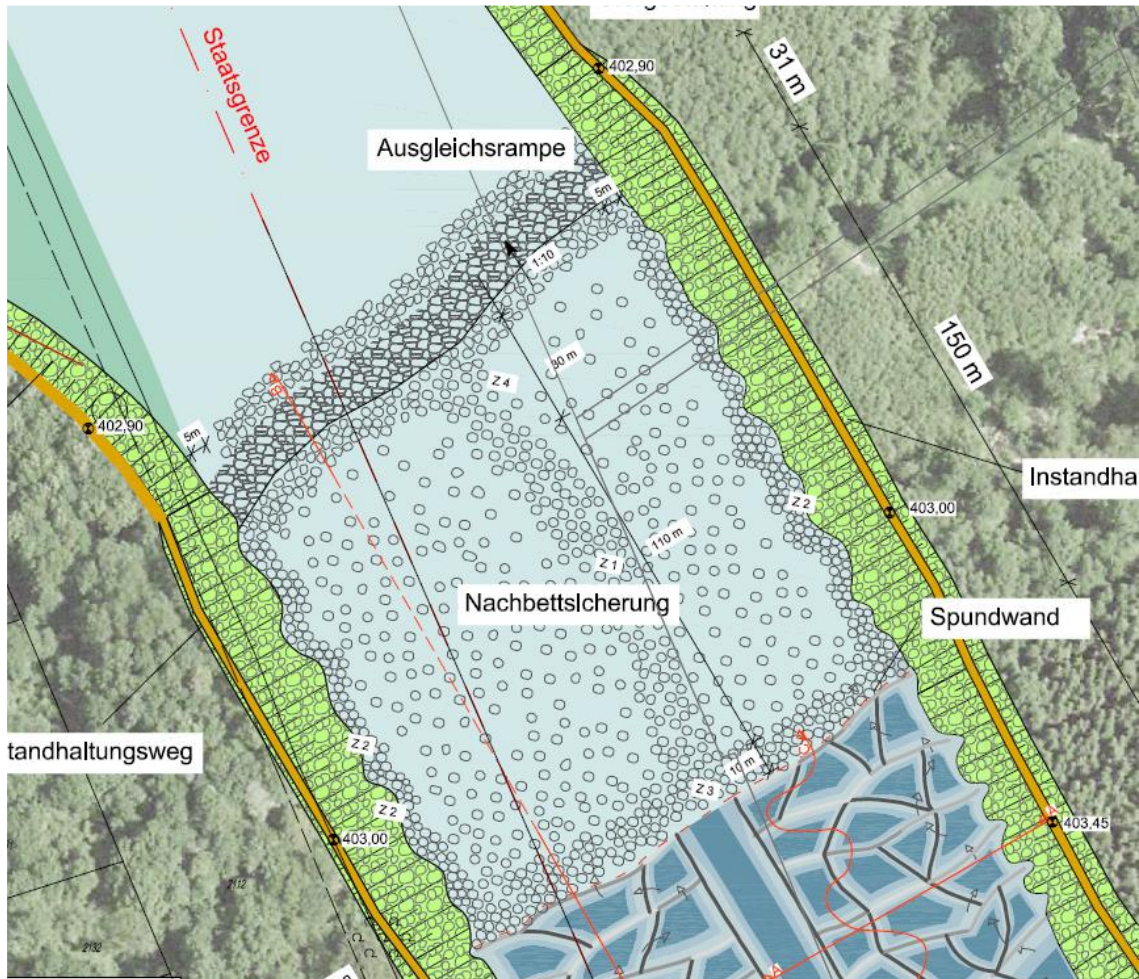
Sanierung Untere Salzach, Rampe Fkm 55,4, Nachbettsicherung
